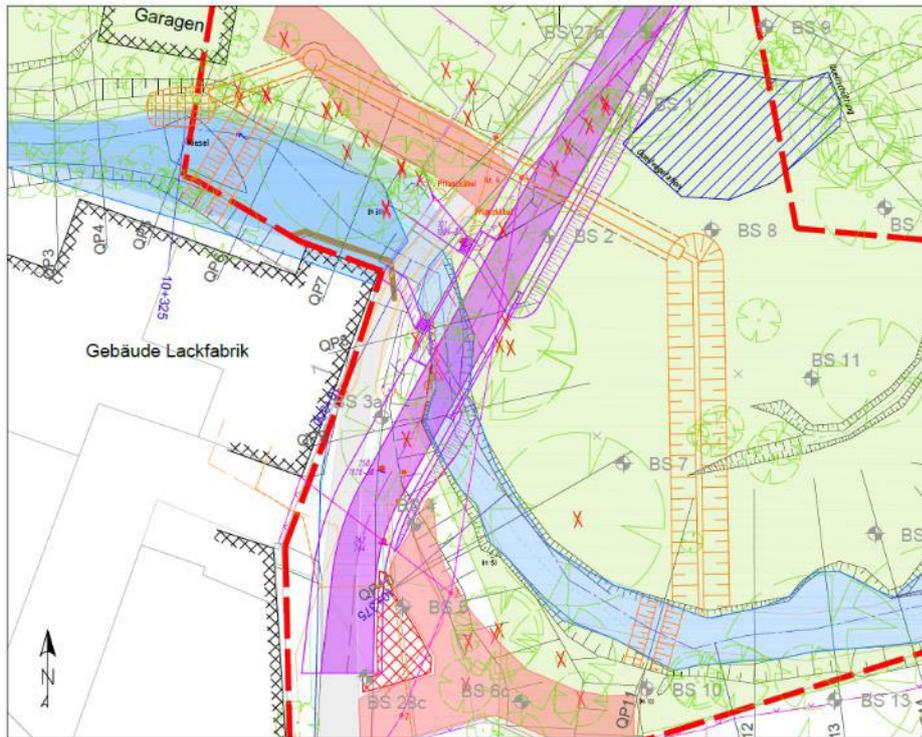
Lageplan Bypass (Auszug BIOTA 2021a)
